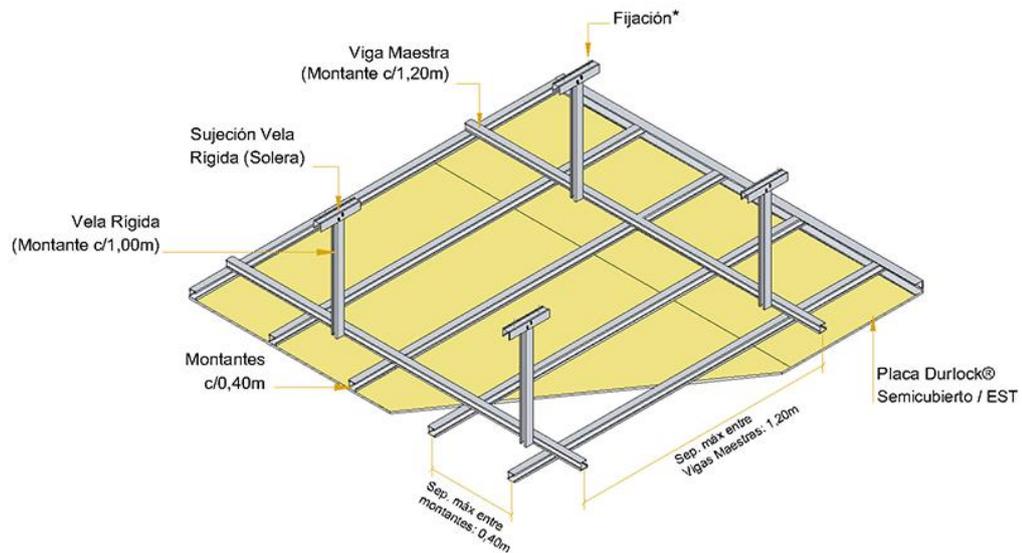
Disposición de perfiles cielorraso suspendido – Fuente: <https://www.durlock.com/>
